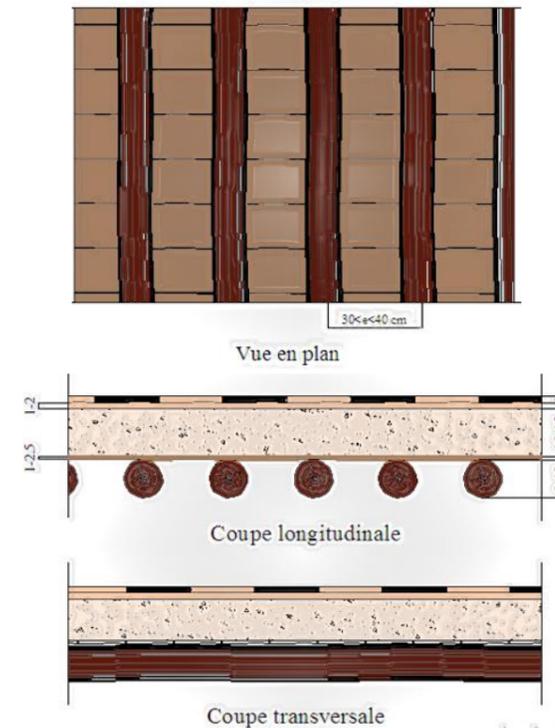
Plancher sur rondins de thuya et voligeage de bois (Source : PPSMVSS, Manuel des typologies architecturales, constructives et architectoniques page 116, traitée par Auteure)
